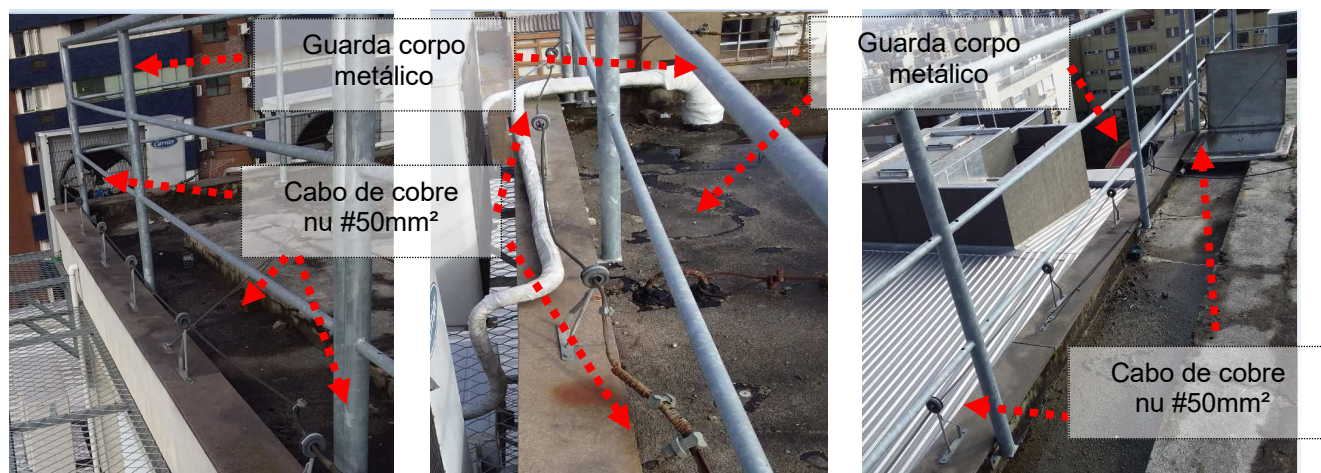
, 04 e 05: SPDA existente na cobertura da edificação.
